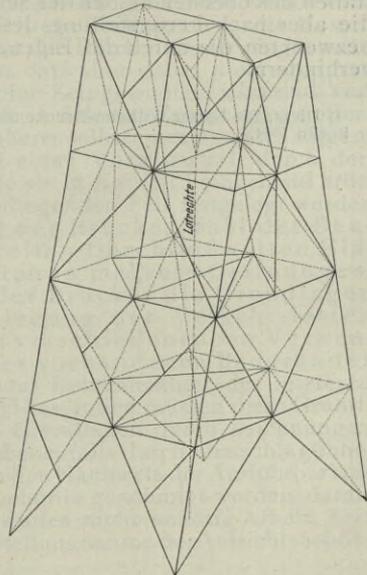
Gerüstpfeiler Kaiser Wilhelm-Brücke bei Müngsten. (Nach Dietz.)
